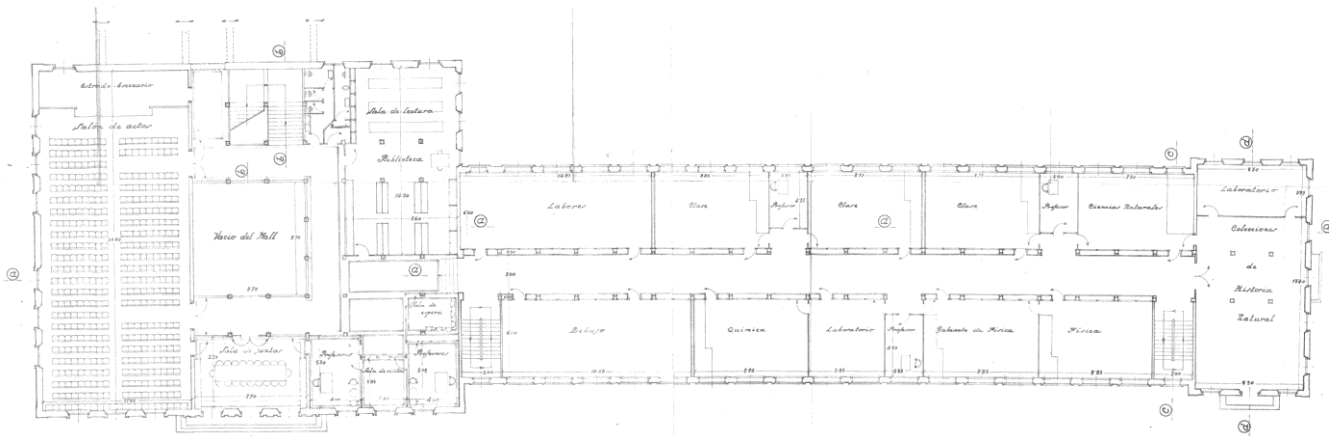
Plano de la planta principal, Manuel Sureda 1942
